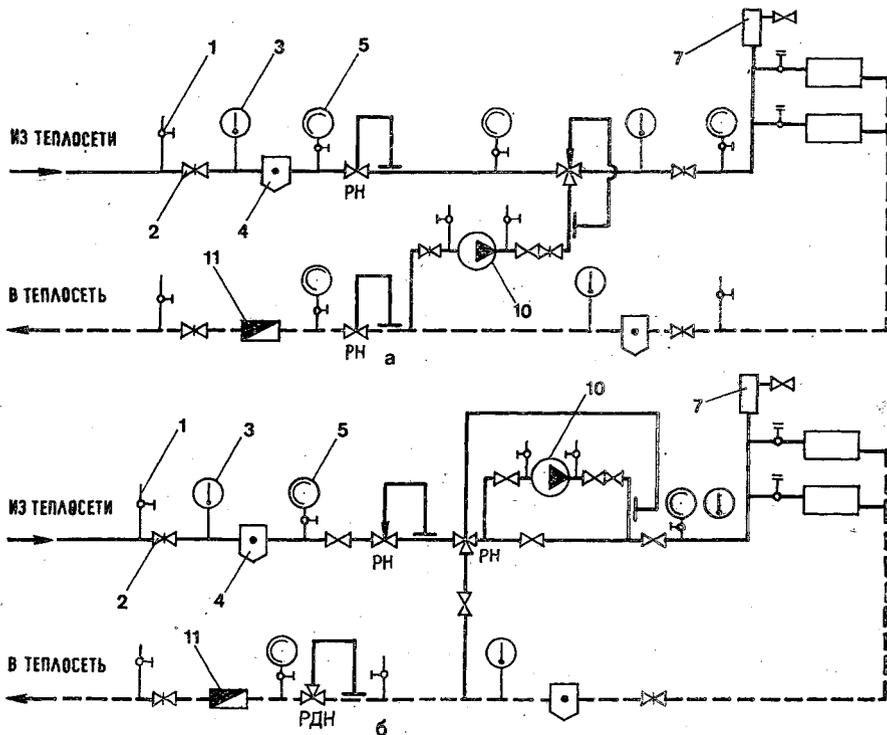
Схемы узлов присоединения систем водяного отопления к тепловым сетям с насосом на перемычке (а) и с насосом на подающем трубопроводе (б) (обозначения 1—11, РР, РД, РН и РДН см. рис. 5.7).
